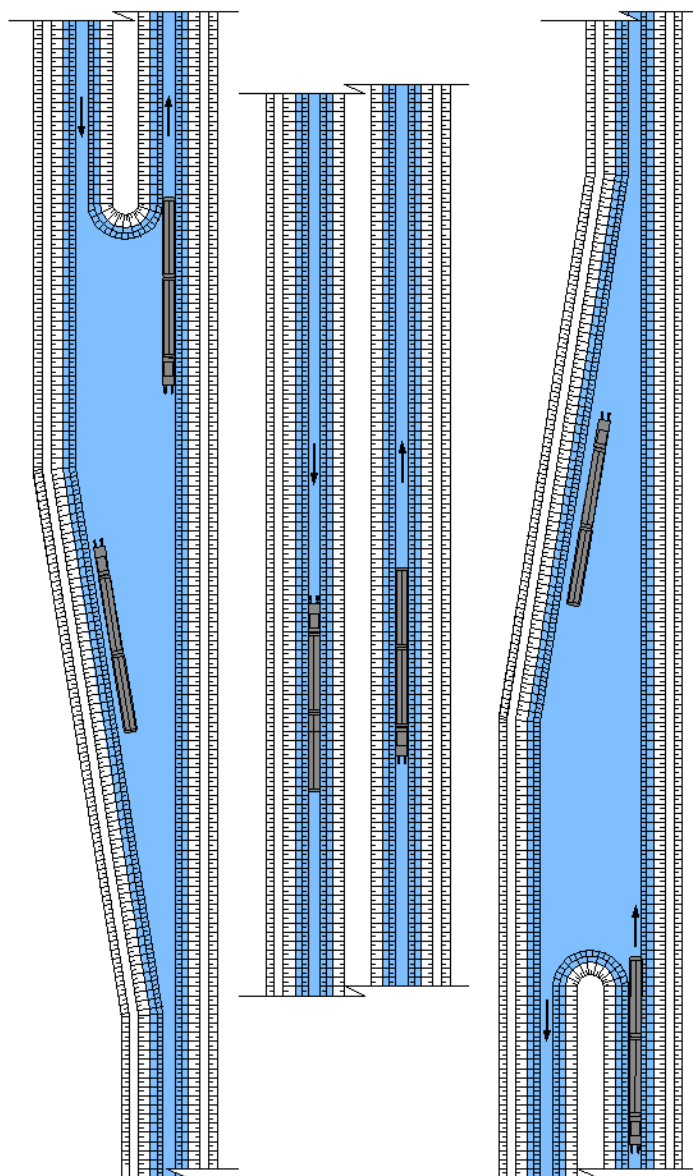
Esquema en planta de canal “by pass”. Extremo sur (izq.), aona central (centro), extremo norte (der.).
